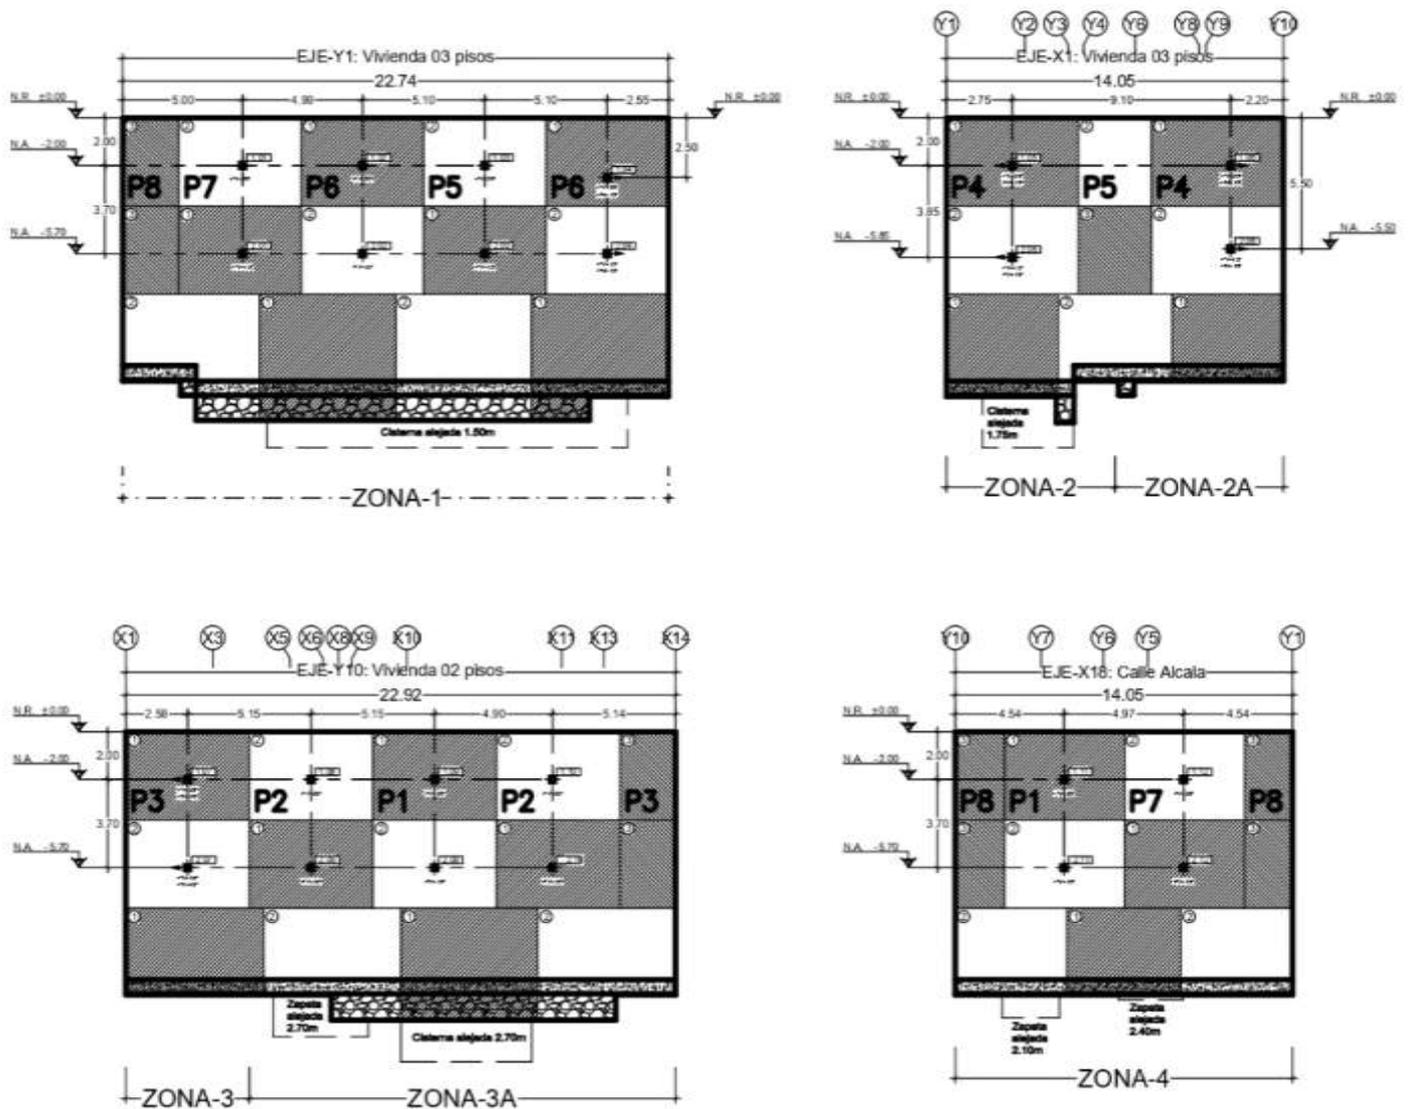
Elevaciones por zonas de los muros pantalla y planificación de los paños a trabajar.
